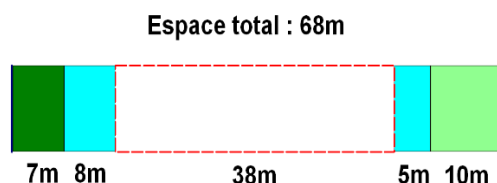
Profil moyen correspondant au profil de la Figure 34 du plan d'aménagement.
